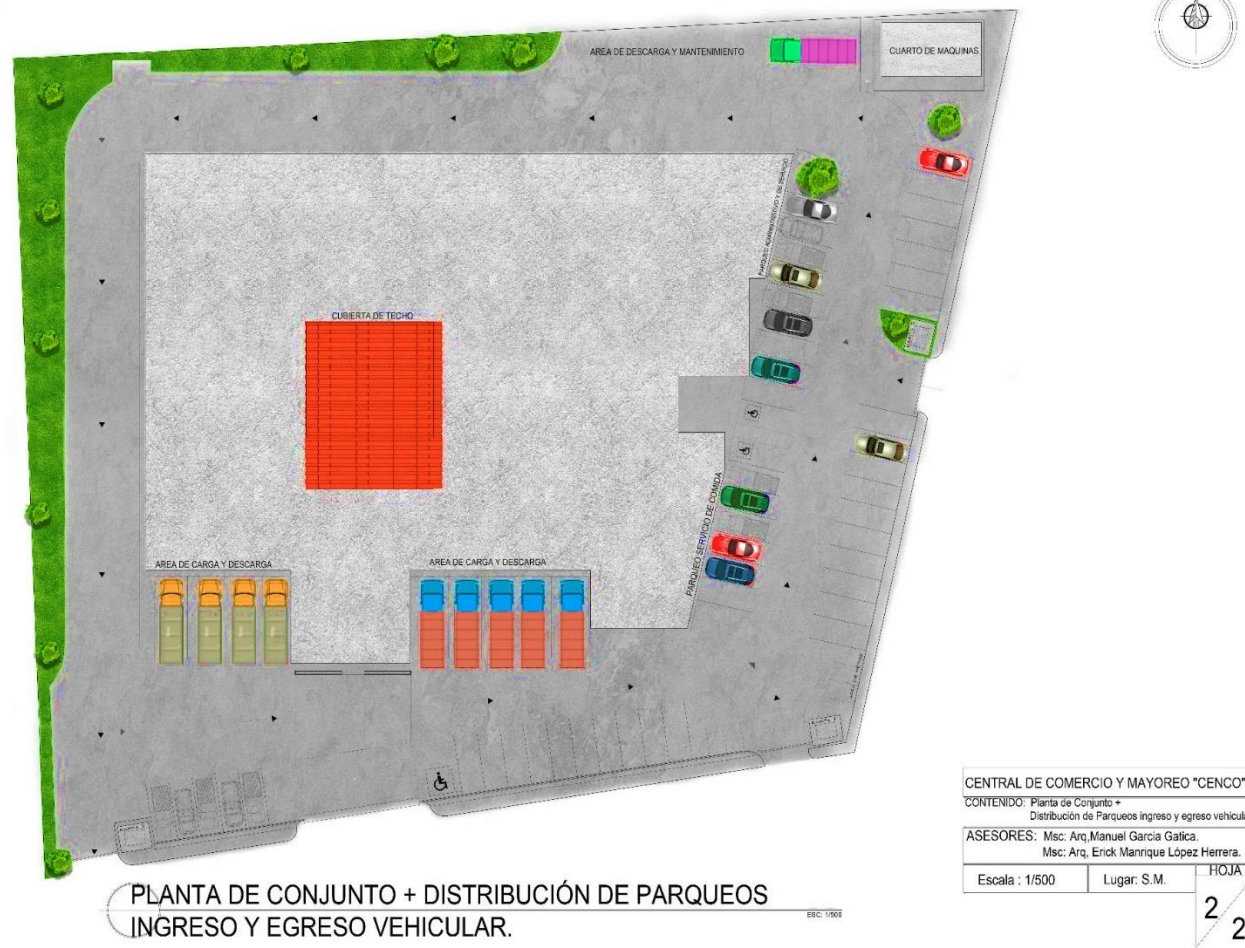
Planta de conjunto, distribución de parqueos. Fuente: Elaboración propia
